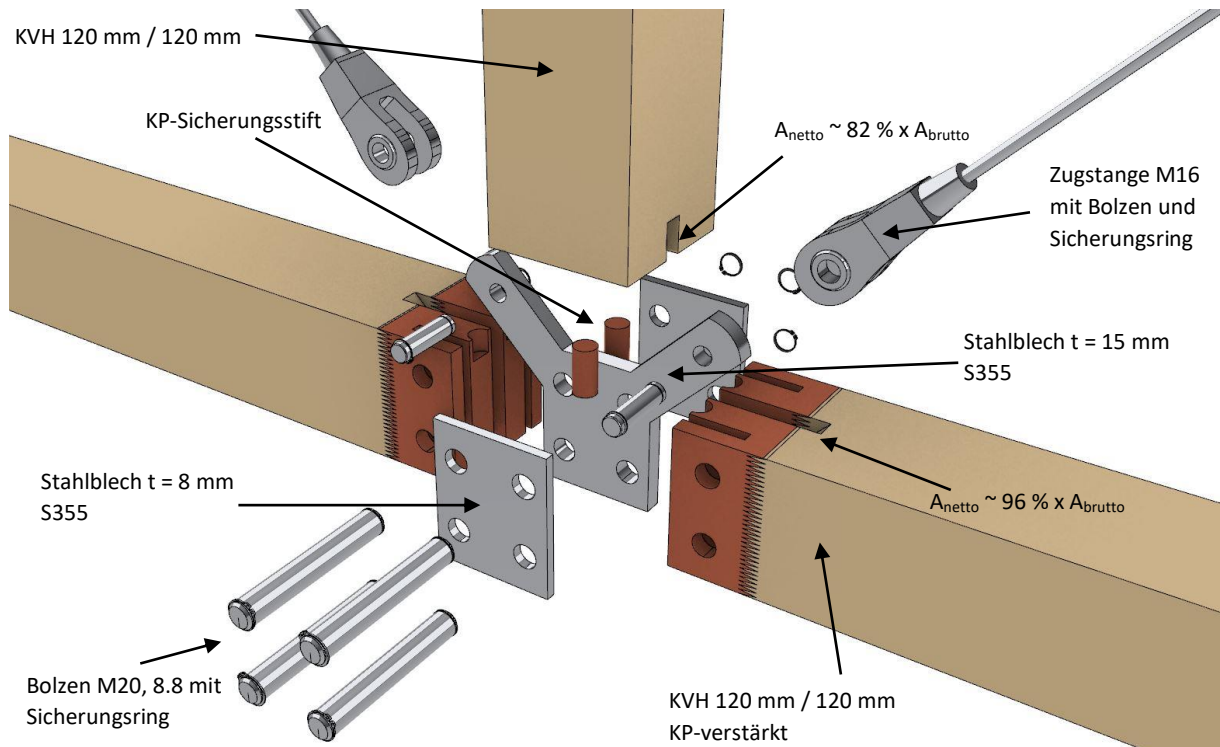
Explosionszeichnung Modulstoß, hier in Feldmitte
